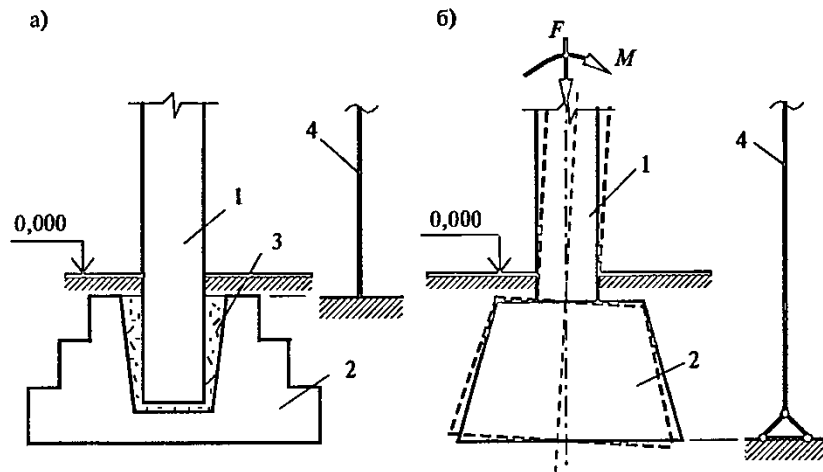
Заделка железобетонных колонн в фундаментах:
